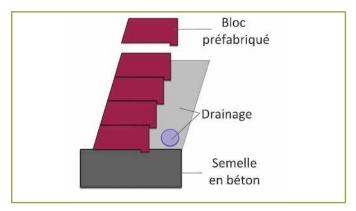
Schéma de principe d'un muret de soutènement en éléments préfabriqués empilables (Dessin de Cédric Houel)
